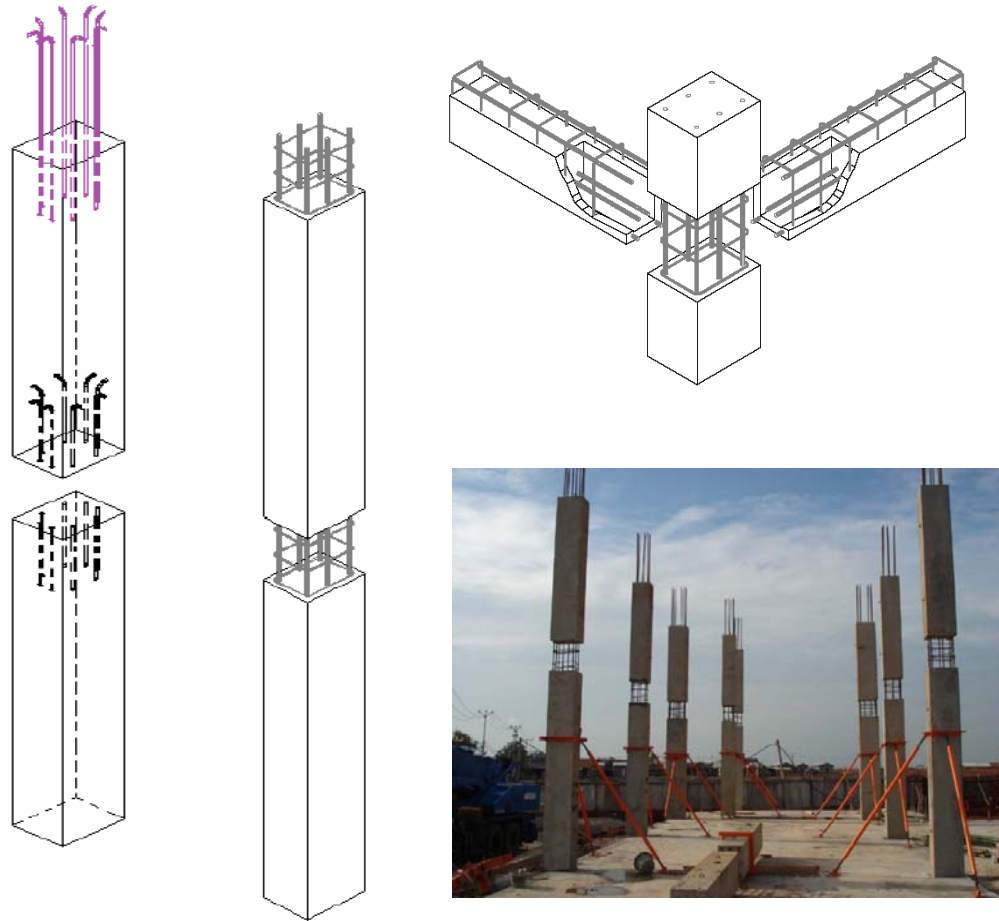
Sistem Struktur Pracetak Bresphaka (Pertemuan Kolom–Kolom)
